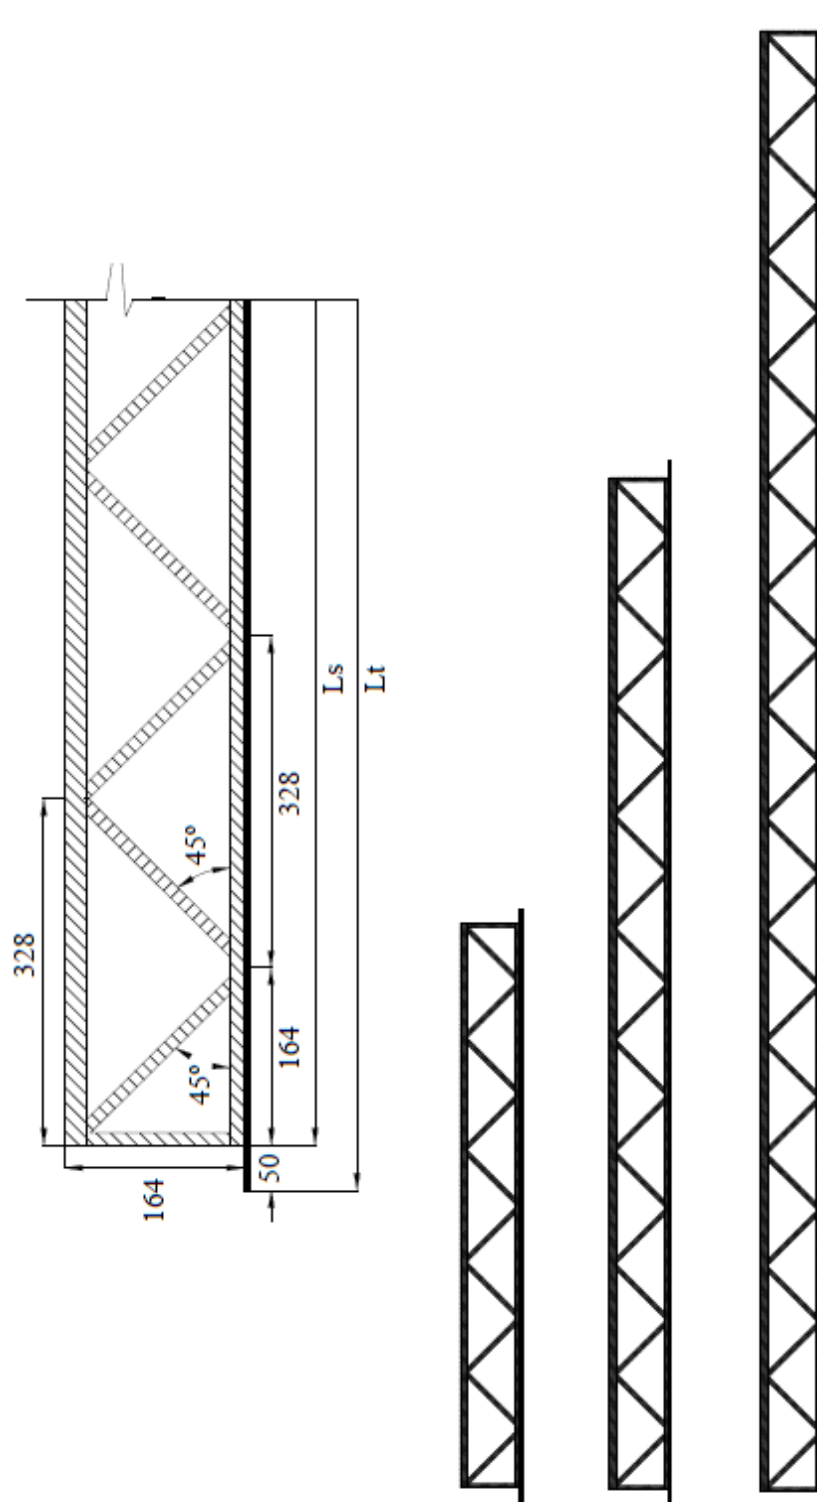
Secciones Longitudinales fase SI, tipo A
